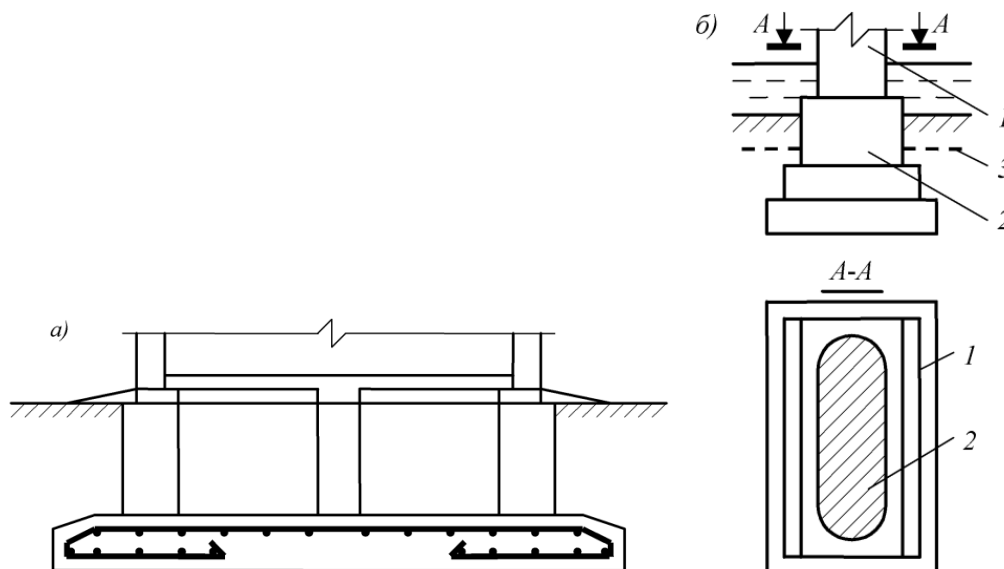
Суцільний плитний фундамент водонапірної башти (а) і масивний фундамент проміжної опори моста (б): 1 – тіло опори; 2 – фундамент; 3 – рівень максимального розмиву ґрунту
